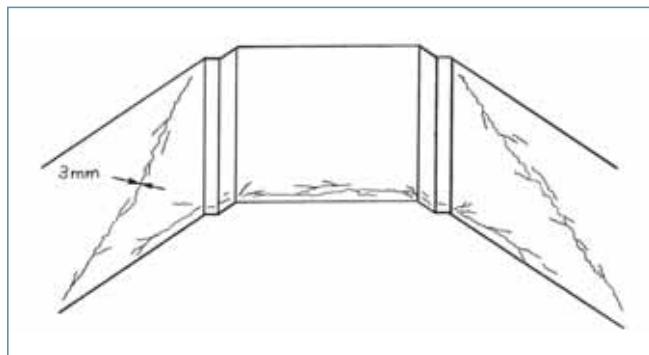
Vista según D (figura 3) a la altura de la planta baja.
